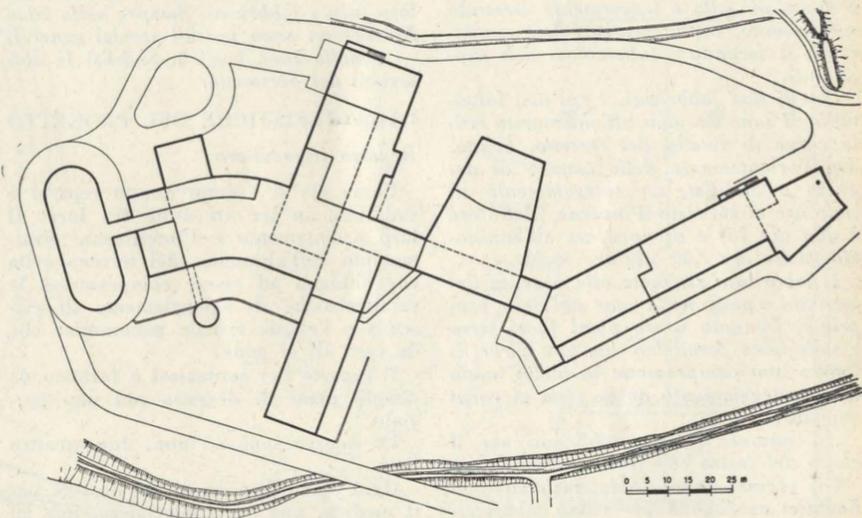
Planimetria generale del complesso sanatoriale. Nel fabbricato di sinistra, con pianta ad anello, sono installate la centrale termica, la lavanderia e la stireria. Il corpo ad esso unito, leggermente arquato, è relativo agli ingressi, all'amministrazione, agli impianti di cucina. Le due ali centrali sono destinate alle degenze degli adulti: quella in alto per i malati contagiosi, quella in basso per i non contagiosi. Viene qui il corpo del teatro e, tutto a destra, l'ala dei bambini con, all'esterno, il padiglione dei giochi.
